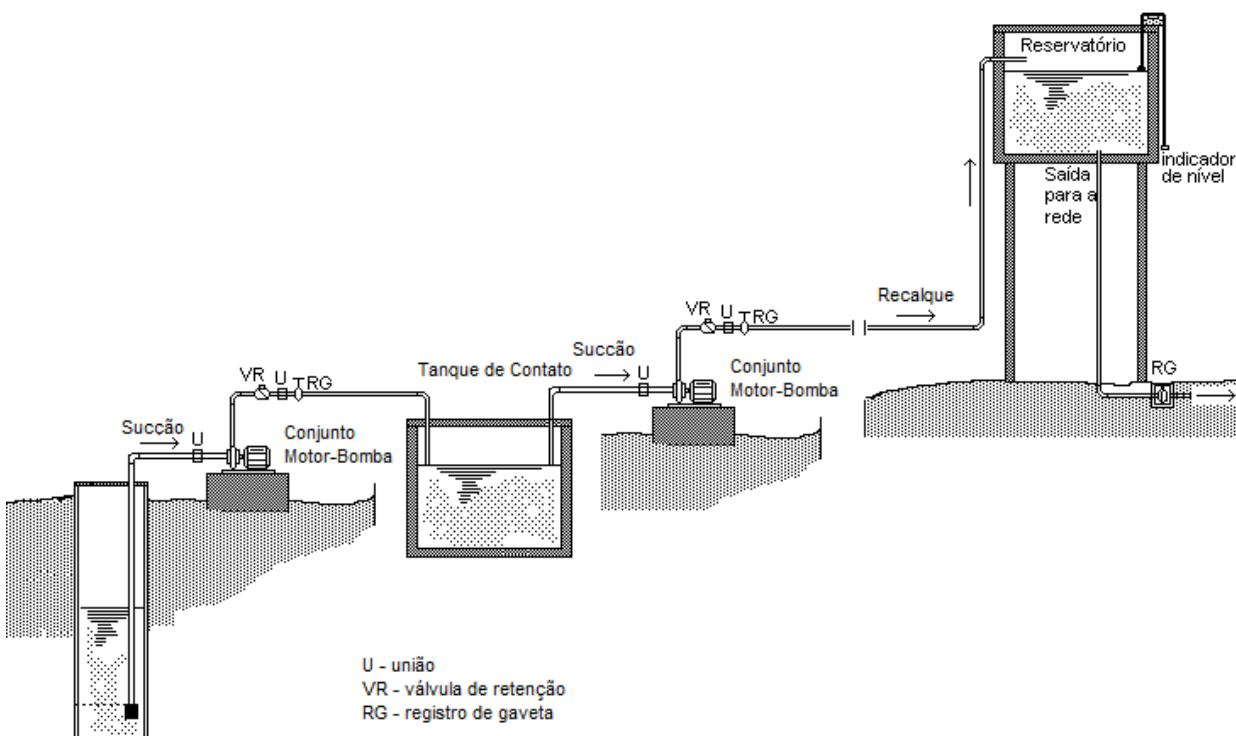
Esquema em corte perfil da captação e elevação de água subterrânea. Adaptado de Filho (2012).
